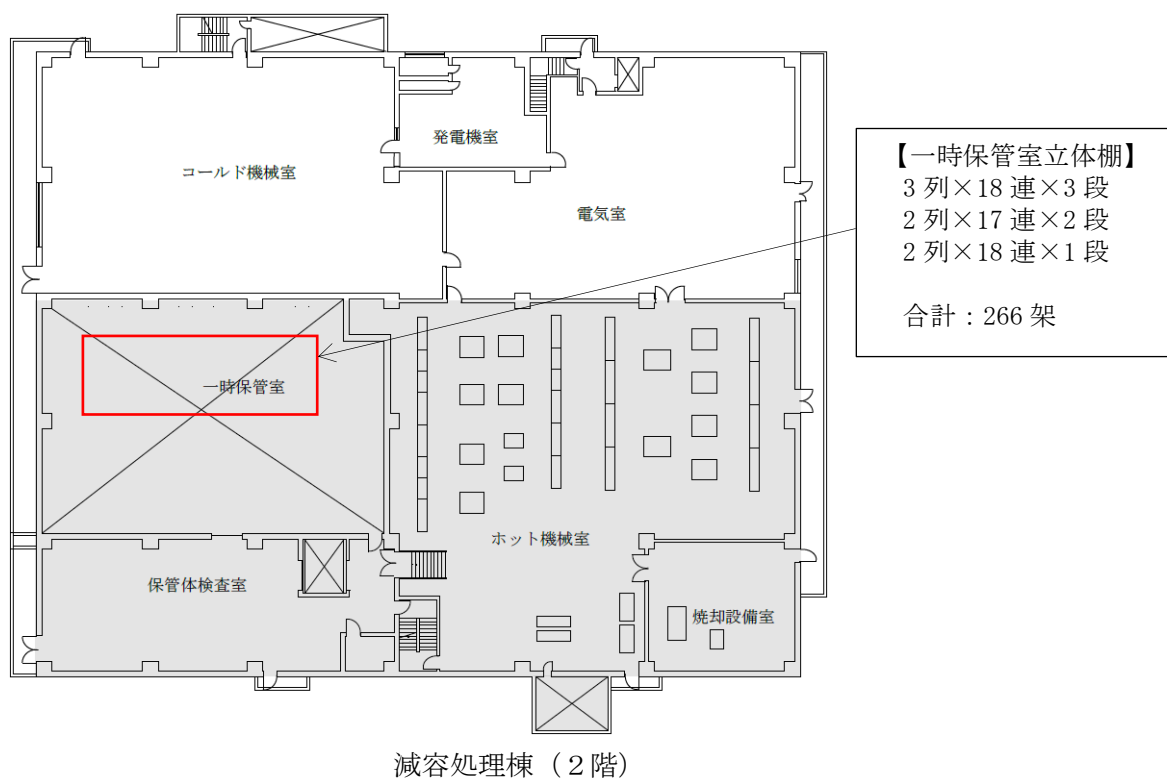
(3/3) 減容処理棟処理前及び発生廃棄物保管場所（一時保管室）平面図
